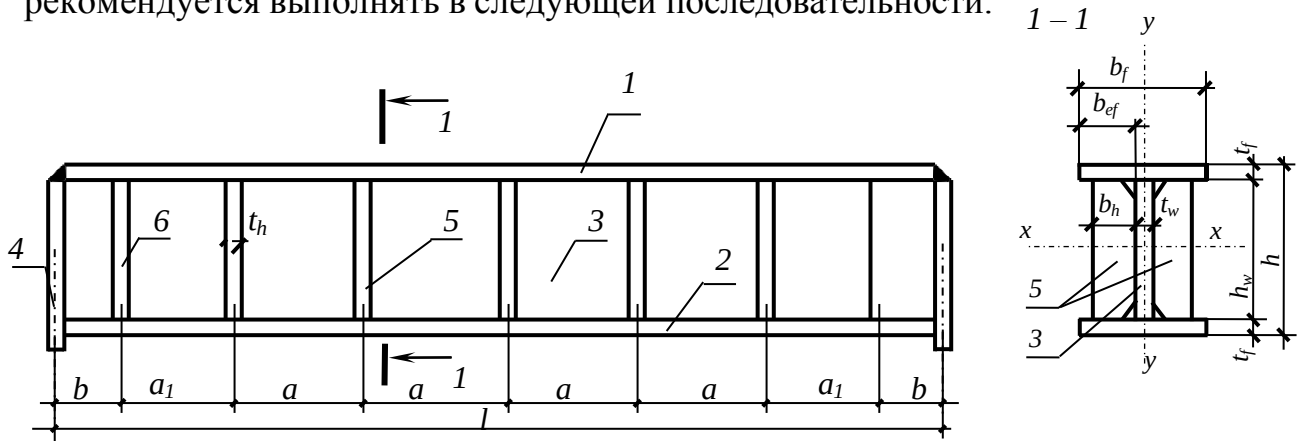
Схема балки с гибкой стенкой симметричного двутаврового сечения: 1– верхний пояс; 2 – нижний пояс; 3 – стенка; 4 – торцевое опорное ребро; 5 – основное поперечное ребро жесткости; 6 – дополнительное двустороннее поперечное ребро жесткости
